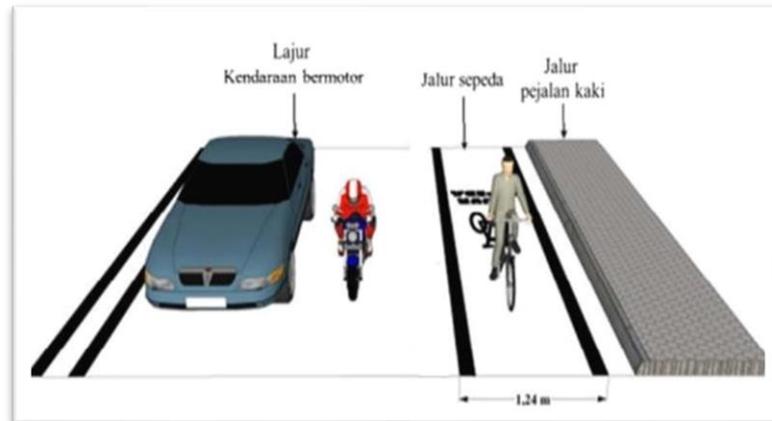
Perspektif Lajur Sepeda Tipe B
